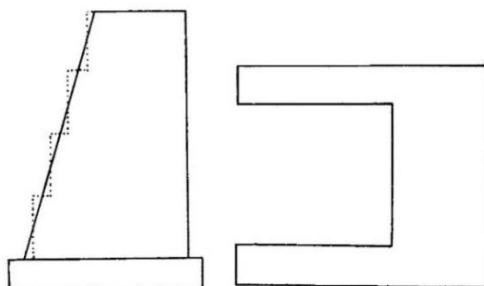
Sezione longitudinale (a sinistra) e pianta (a destra) di una spalla da ponte. [11]
